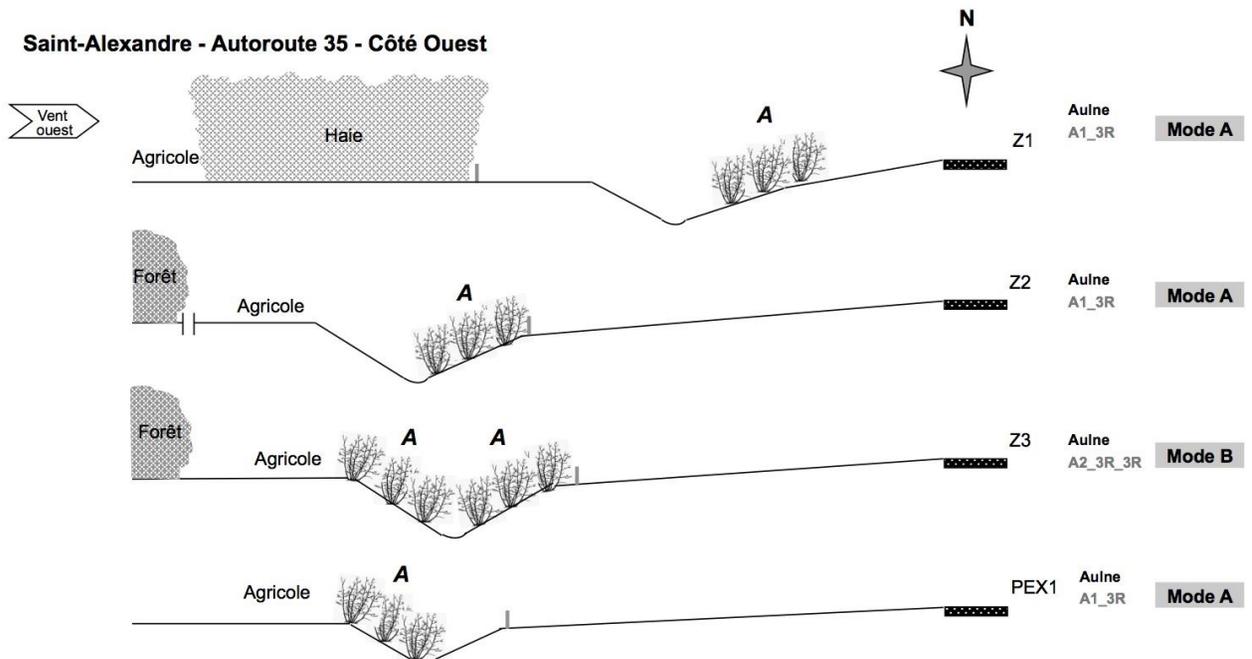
Coupe transversale des zones de plantation sur le côté Ouest de l'autoroute 35.
